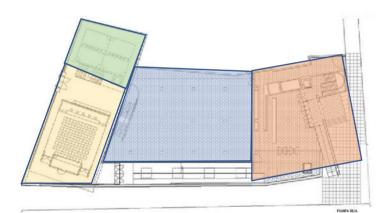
Planta. Fuente: http://www, robertovalle.com/
